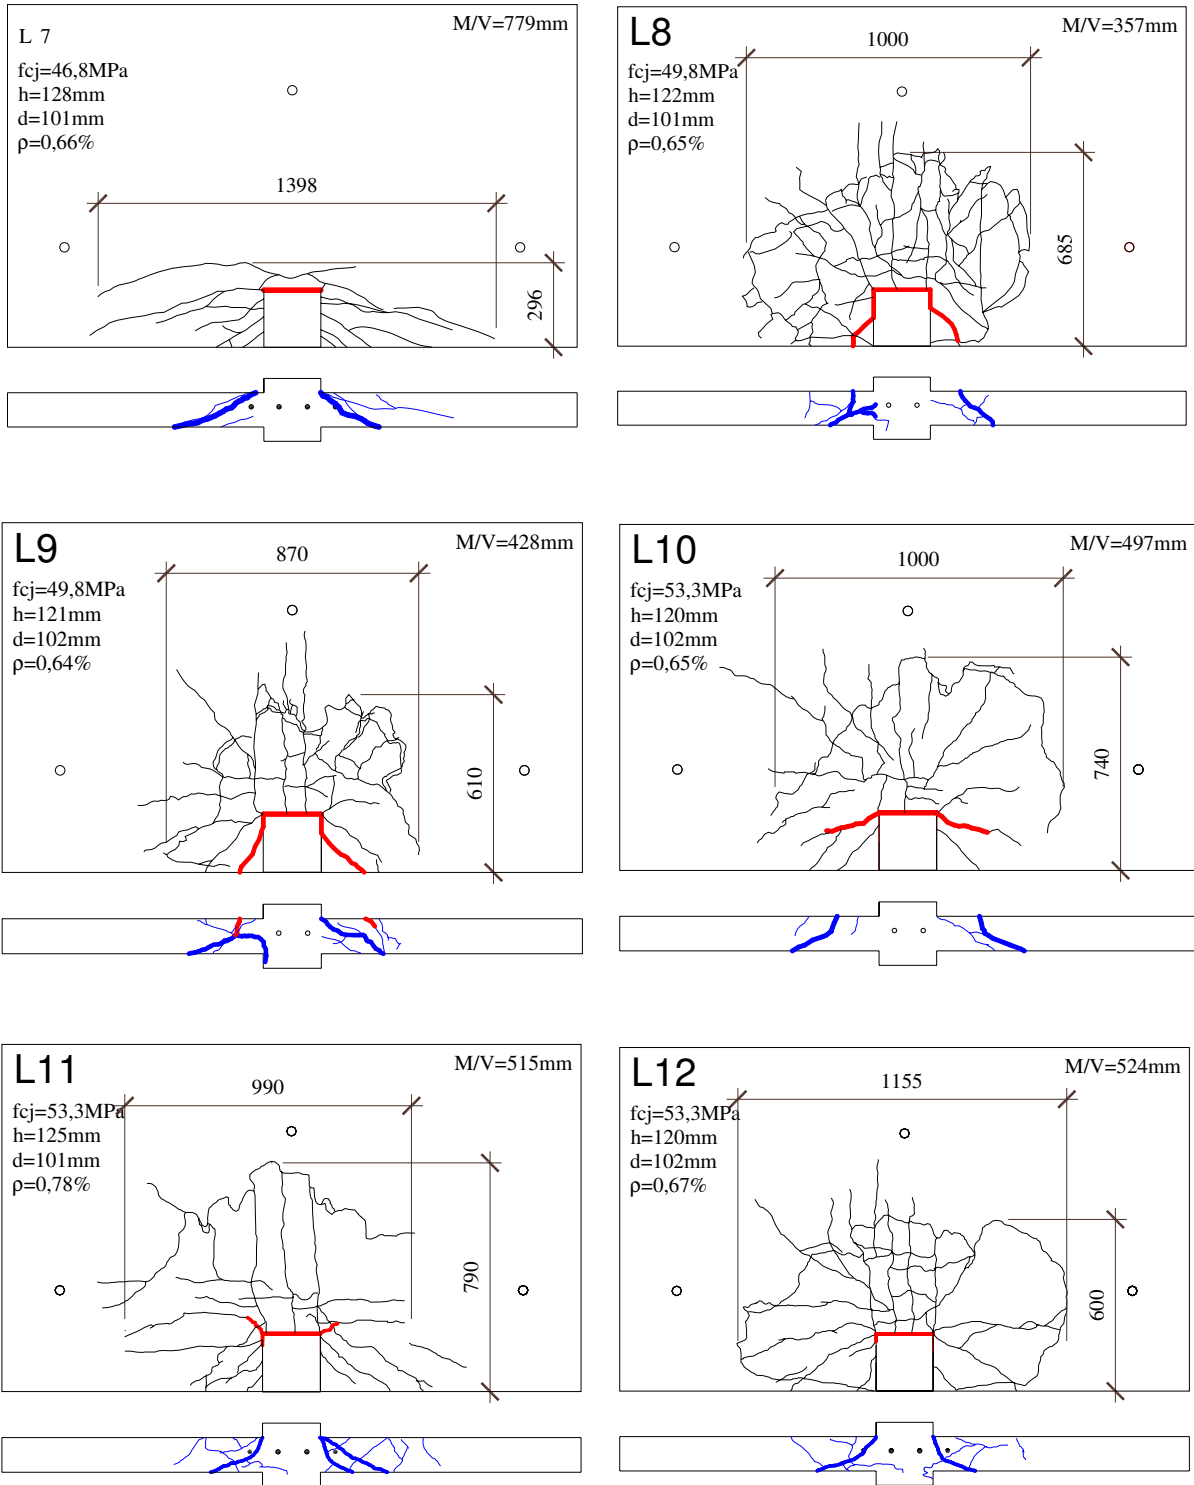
Fissuração e ruptura das lajes L7 a L12
